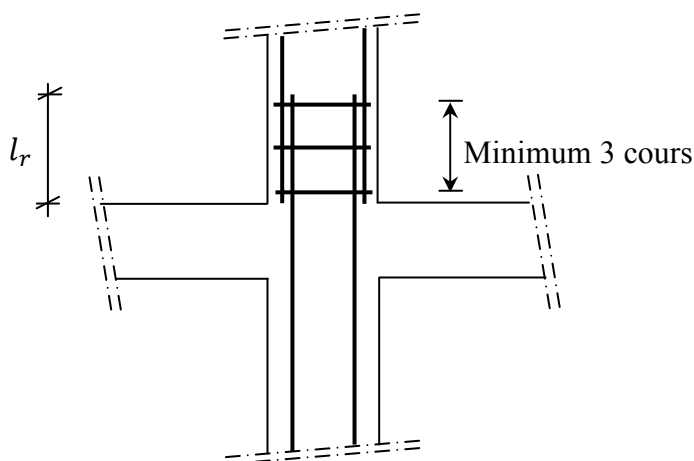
Les armatures transversales dans la zone de recouvrement
